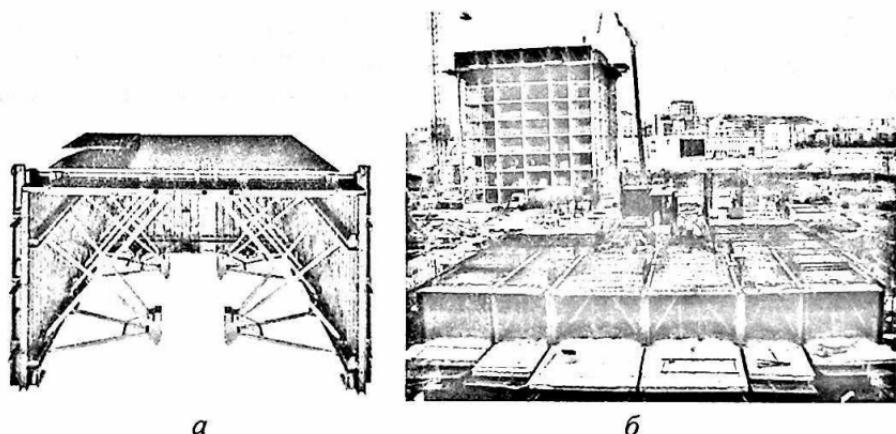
Объемно-переставная («тоннельная») опалубка (а); укладка арматуры и подготовка к бетонированию (б)
